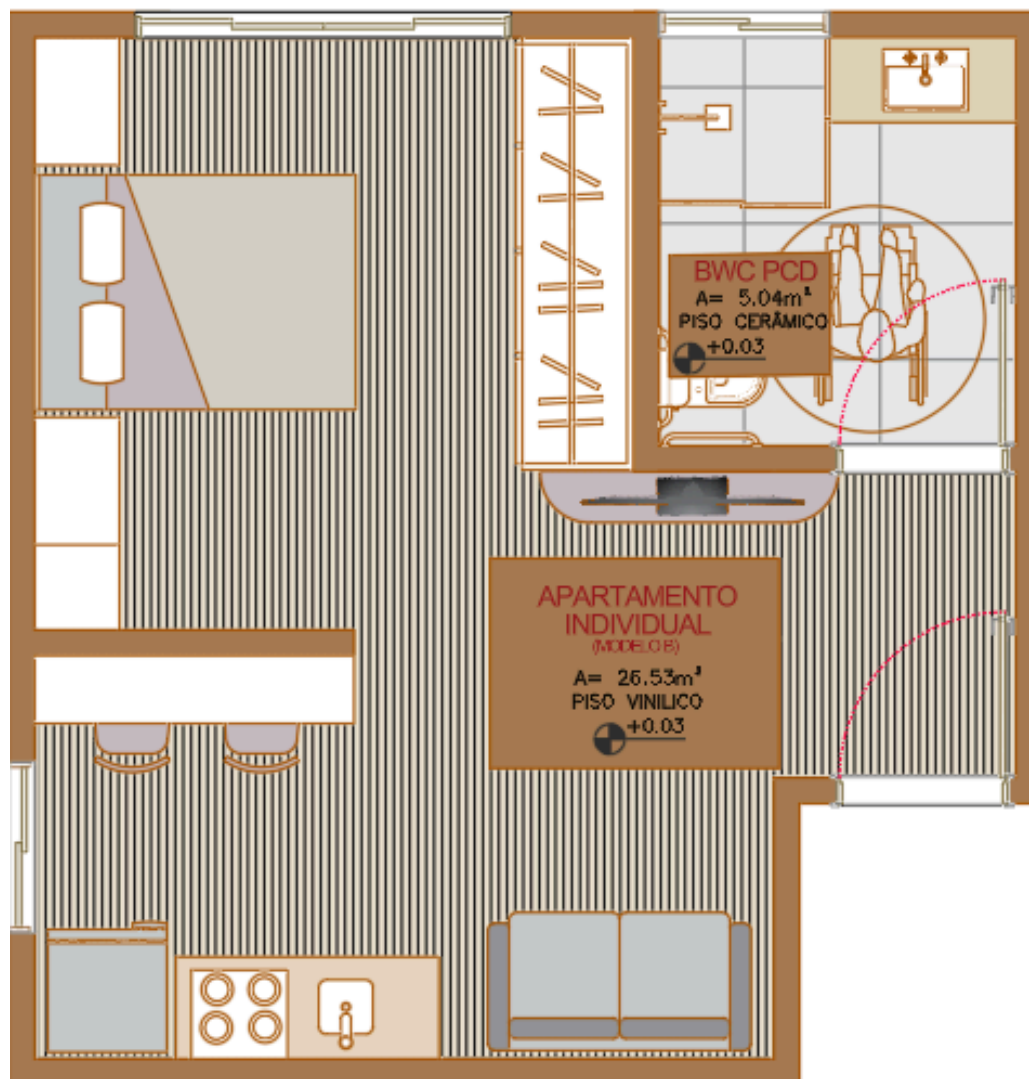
Imagem Planta de Layout do Apartamento Individual Modelo B.
